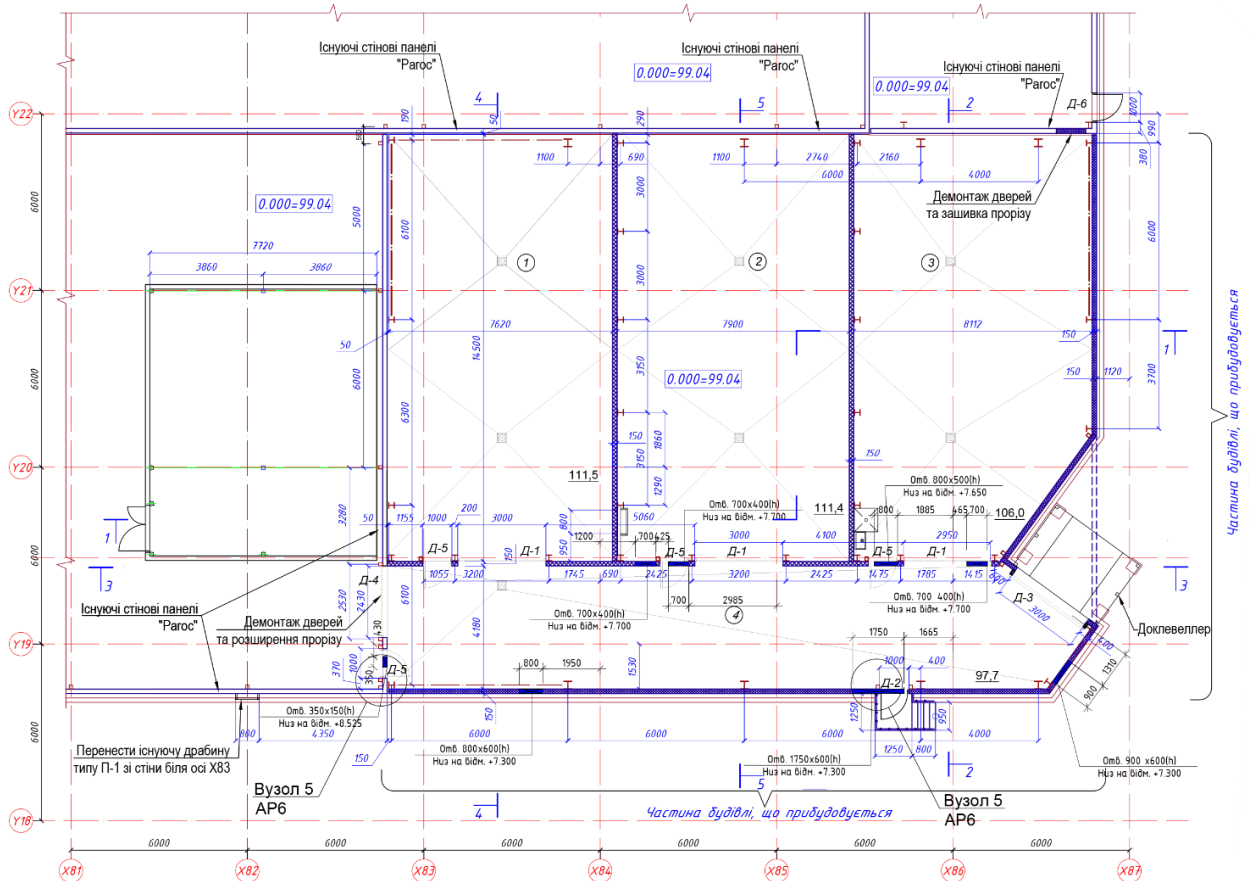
План будівлі на позначці 0,000 м.
